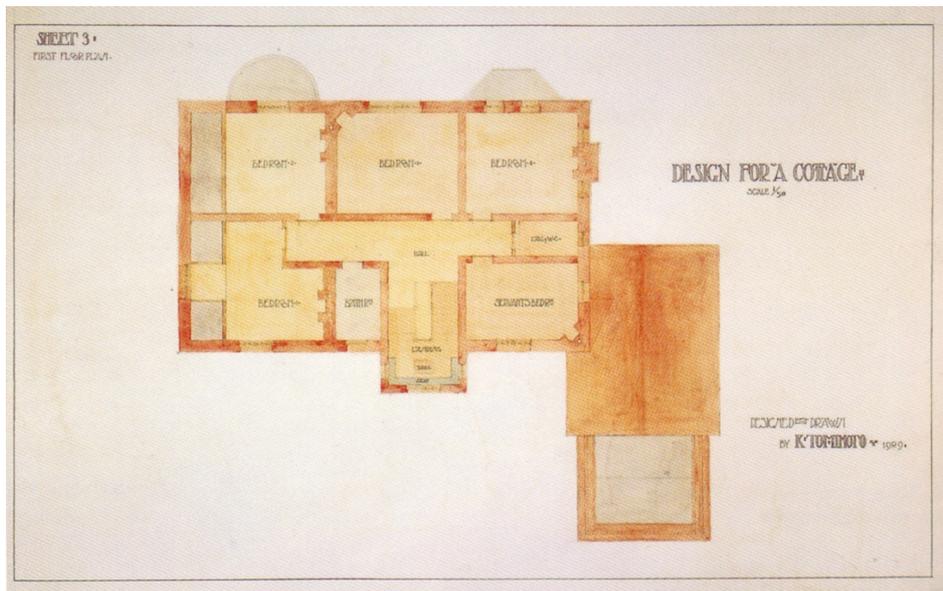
《音楽家住宅設計図案》の2階平面図 (SHEET 3) (東京藝術大学所蔵)。
